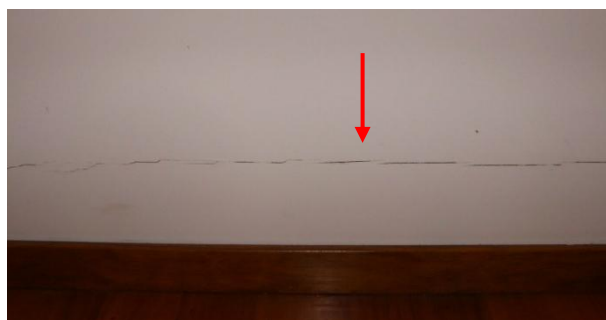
Fissura horizontal em parede de sala
